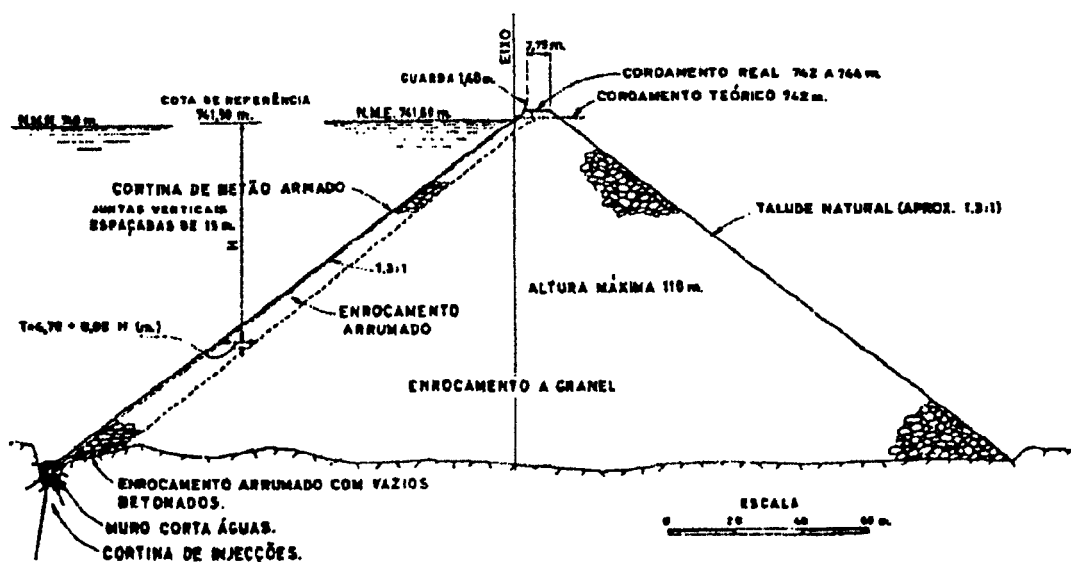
Corte tipo da barragem de Paradela (Fernandes et al., 1960).
